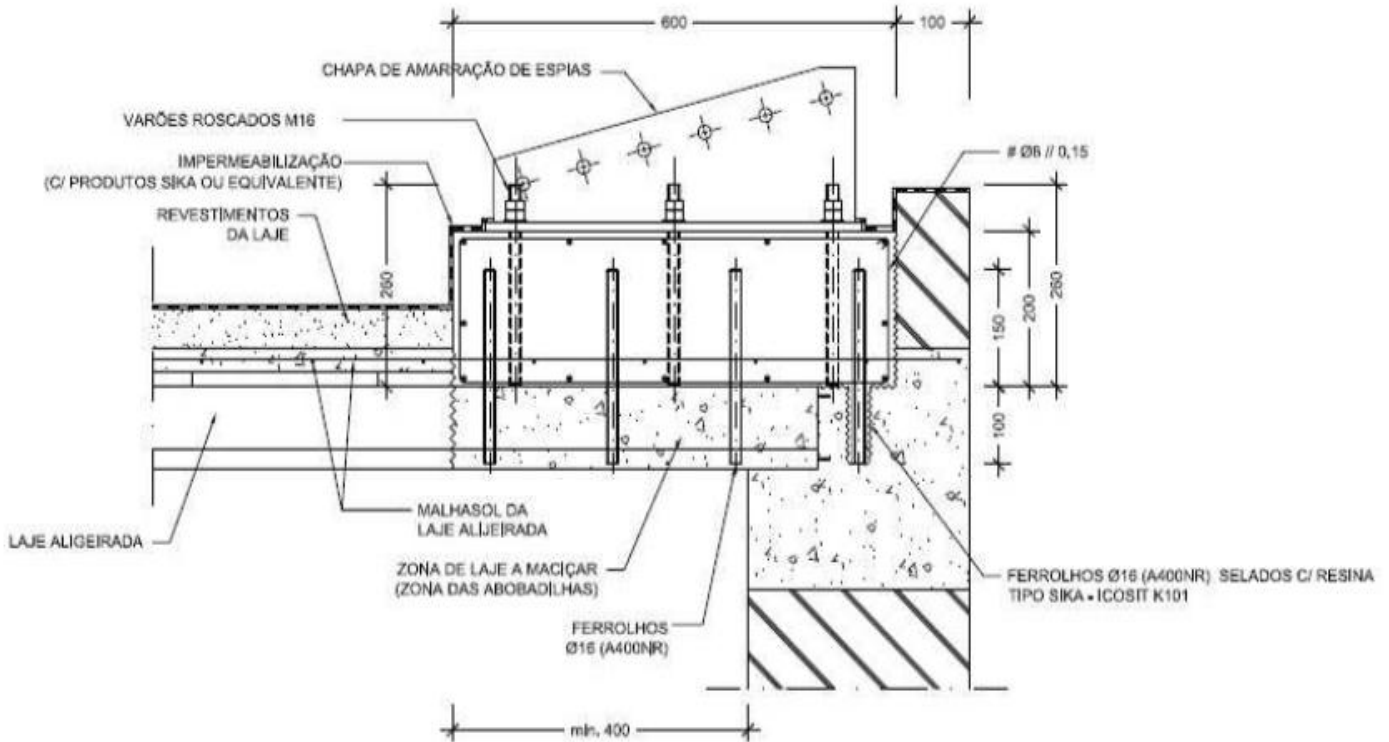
Pormenor ancoragem com amaciamento de laje aligeirada de vigotas e abobadilhas
